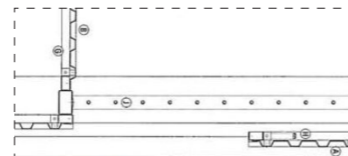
Detalle constructivo 3. Planta de envolvente transparente. Espacio invernadero.
